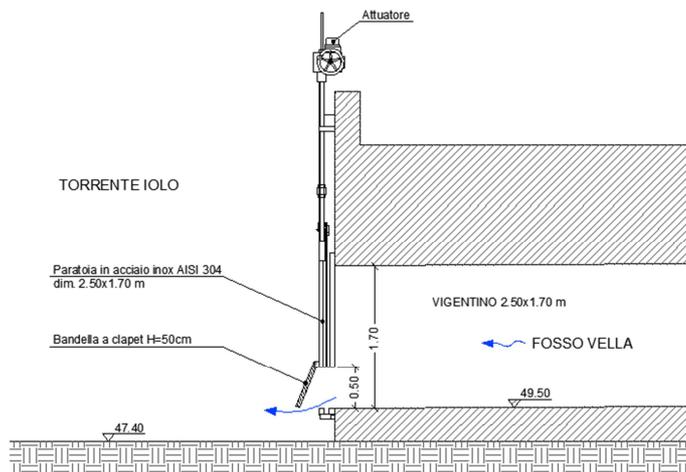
Paratoia di collegamento tra Iolo e Vella – sezione trasversale
